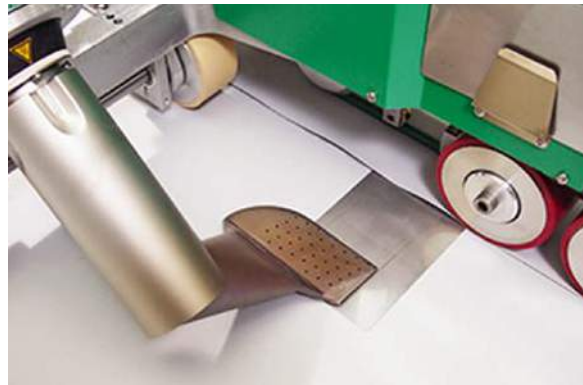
Сварка с использованием металлической пластинки
